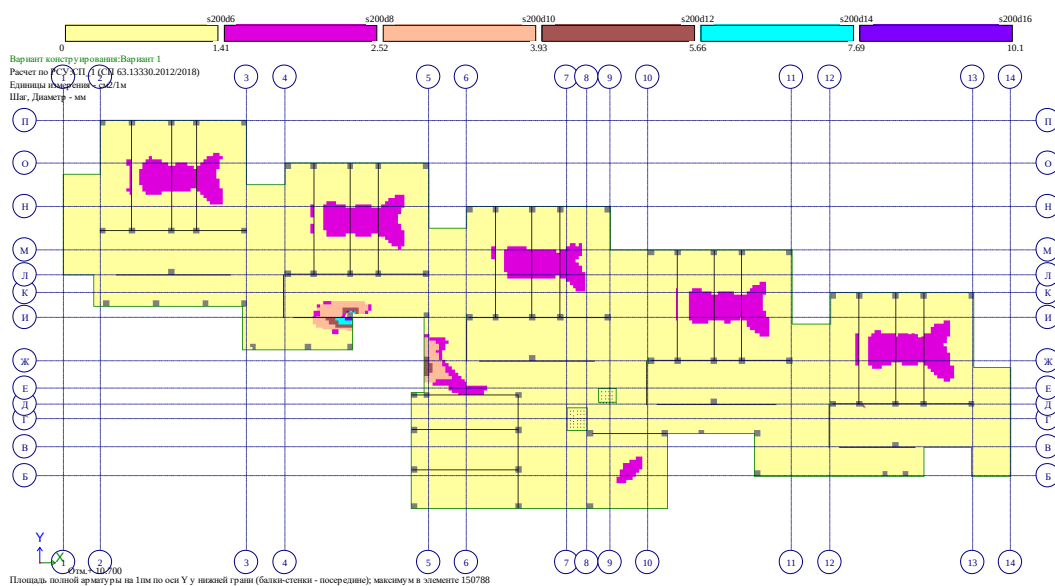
Схема армирования плиты перекрытия у нижней грани
